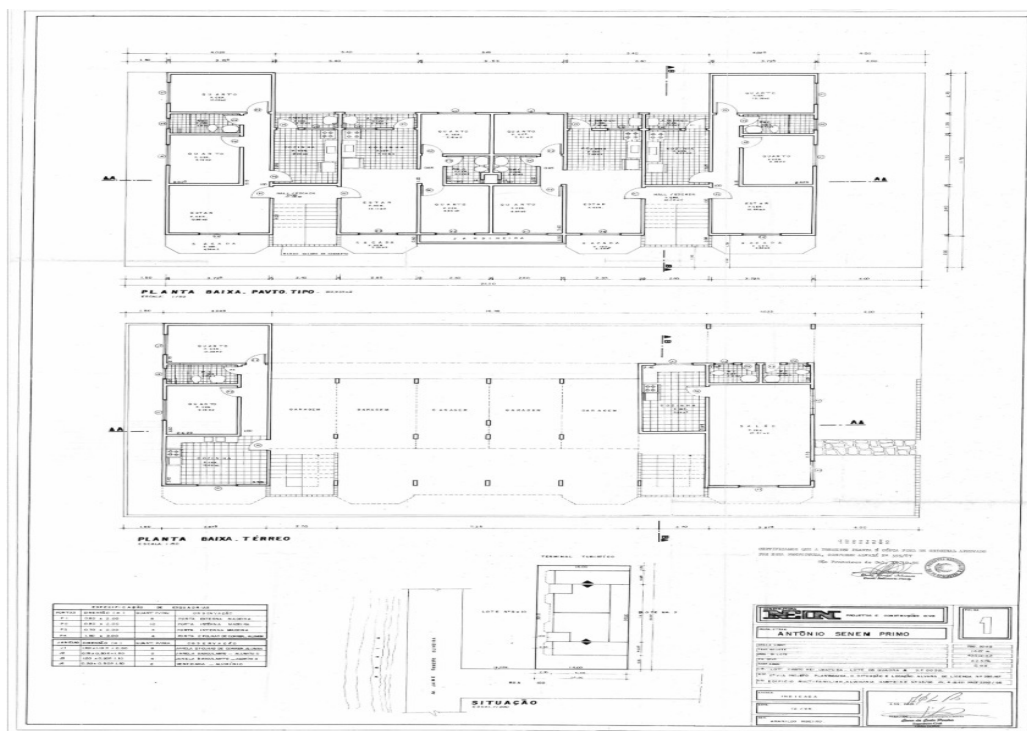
Planta Baixa Térreo (Cond. Giselle II) – Destaque: garagem com 8 vagas e pilares estruturais
